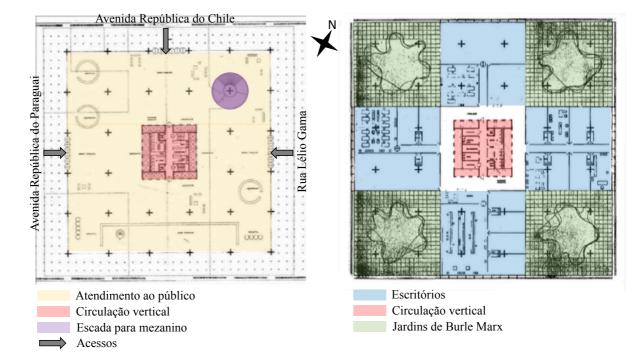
Corte com setorização. Ao lado a disposição das diferentes plantas tipo.
